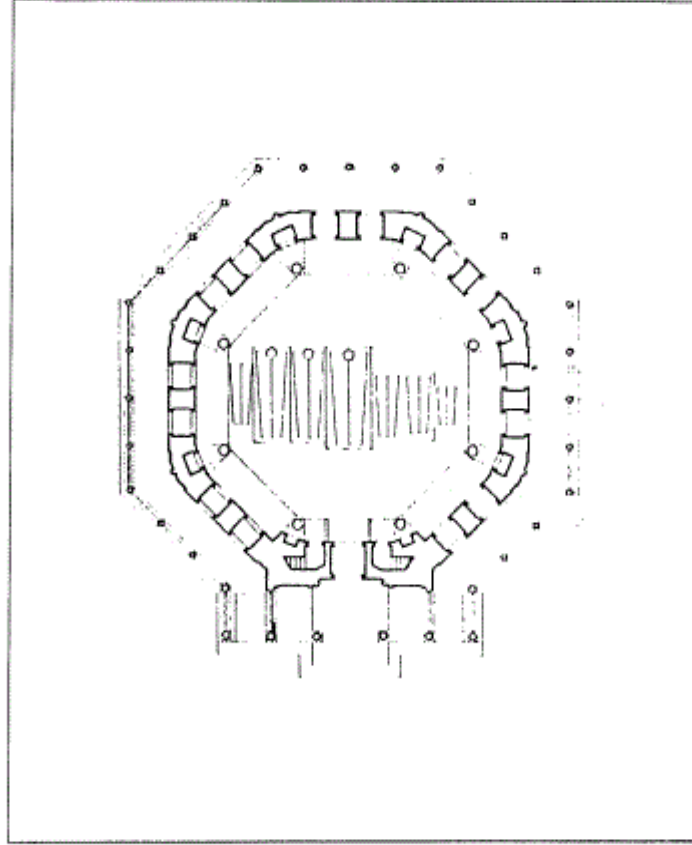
مسقط أفقي لترية سليم الثاني في مدافن أبا صوفيا بإستانبول (عن : اصلان
